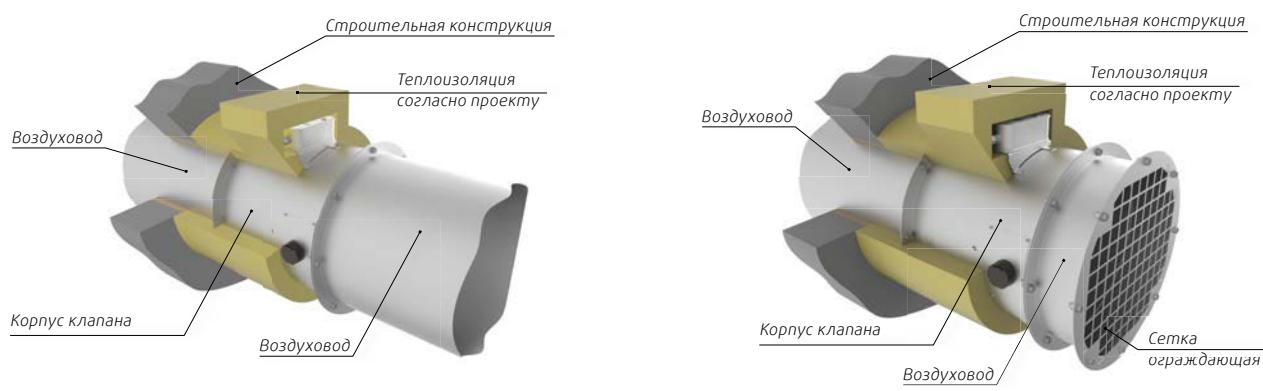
Схема монтажа клапана круглого сечения вне проема строительной конструкции
